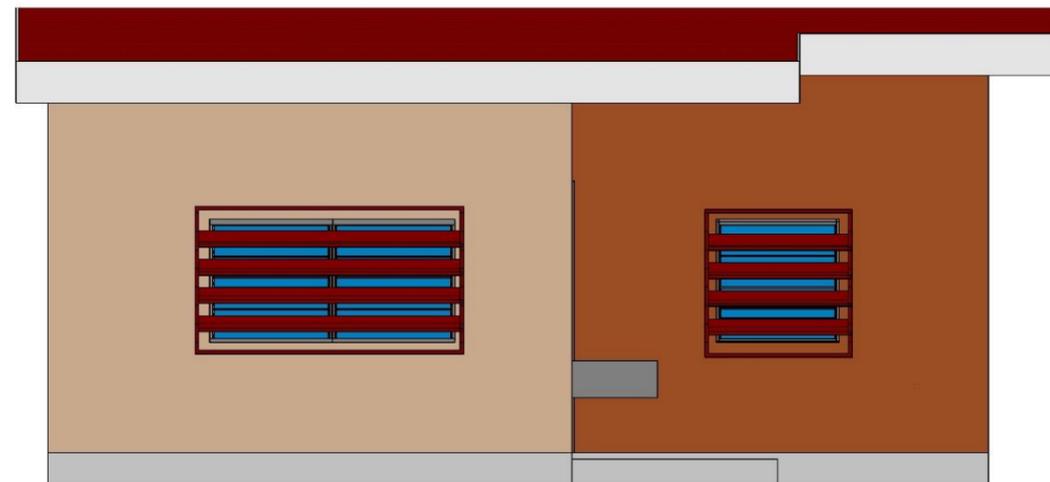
Fachada Oeste - Vivienda Modelo C-12.
